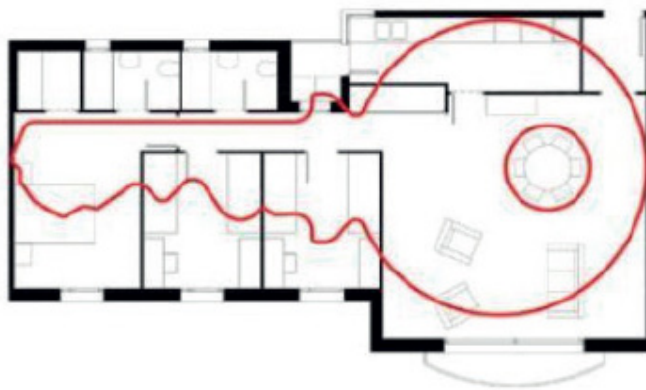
| Planta em chave, ilustrando a hierarquização da casa
